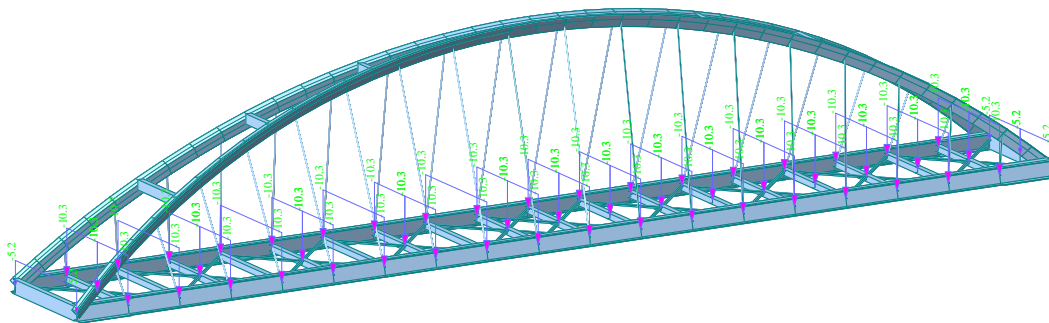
Distribuzione Carichi Permanenti Pavimentazione
